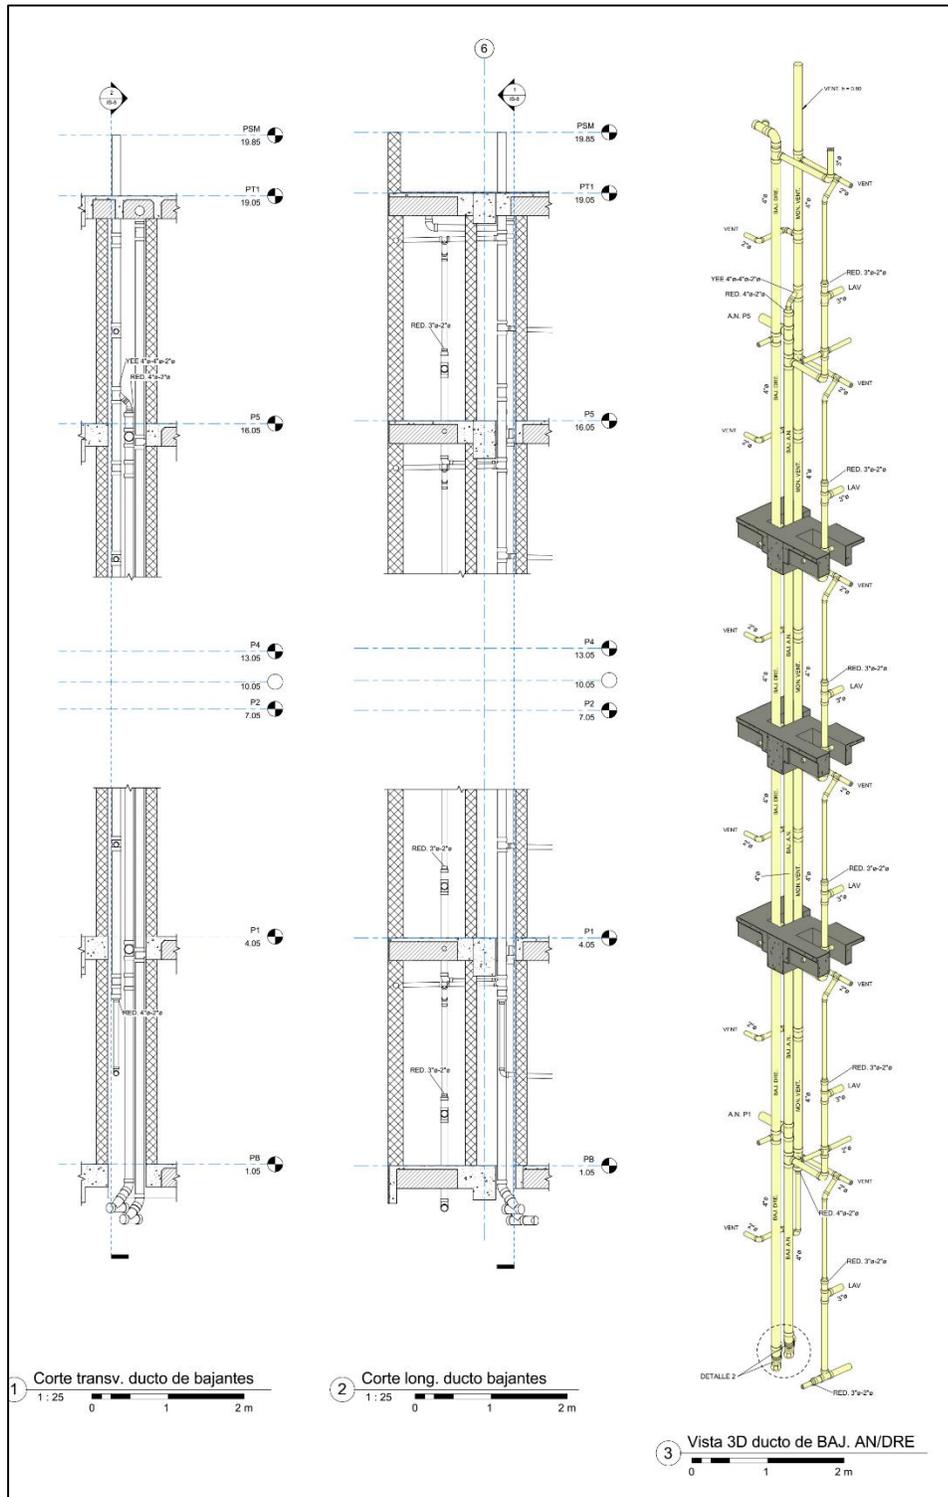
Vistas transversales y 3D del ducto de bajantes/montantes (Revit).
